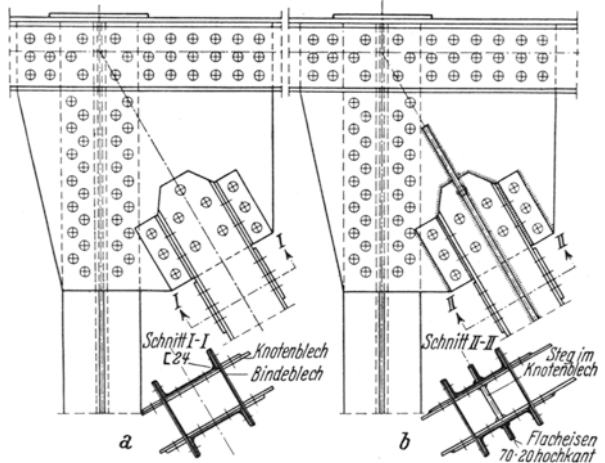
Brückenverstärkung durch Schweißung.
